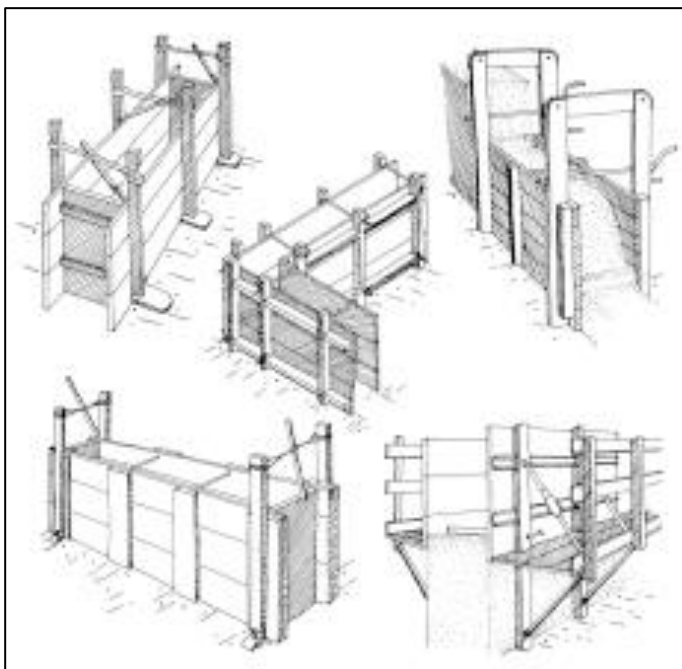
Detalles de encofrados para la construcción del tapial parasísmico.
